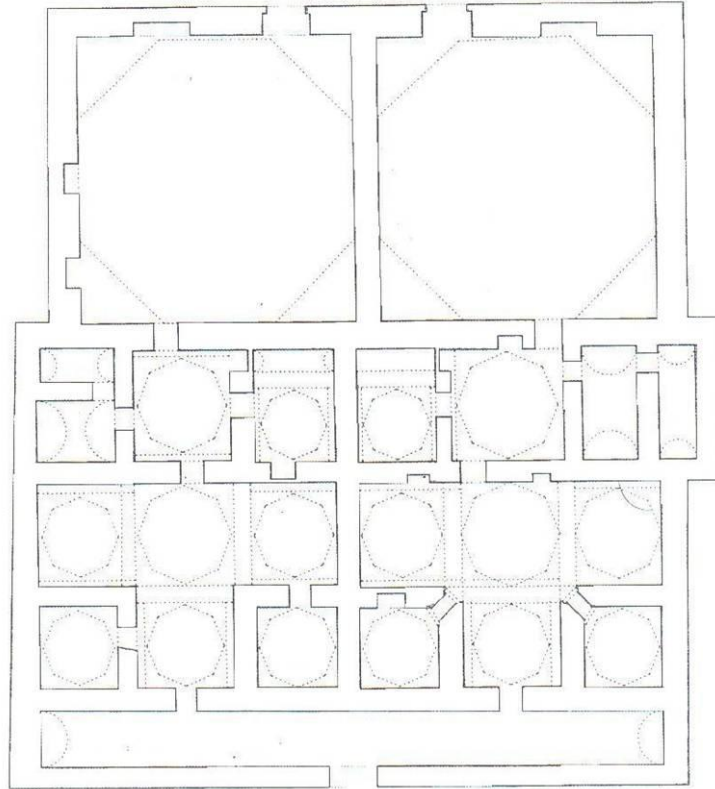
Hacı Hamza Hamamı (İznik) plan şeması
